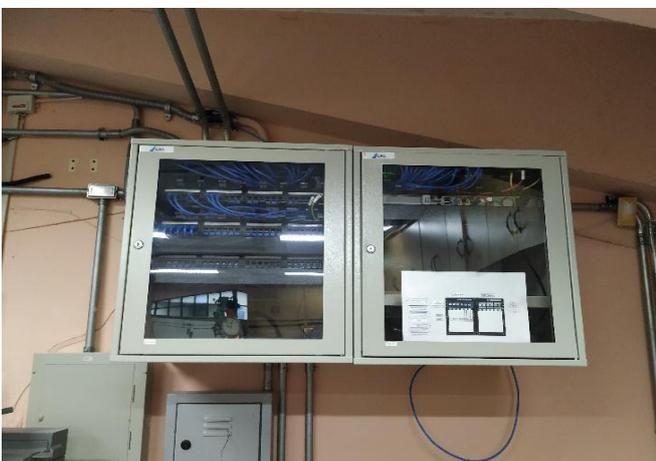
Rack dos switch e equipamentos de lógica, secretaria.
